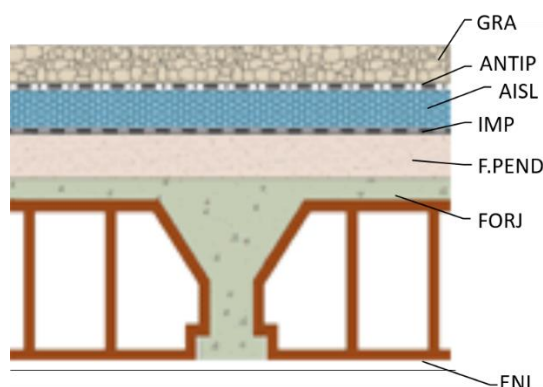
Sección cubierta plana invertida con protección de grava
